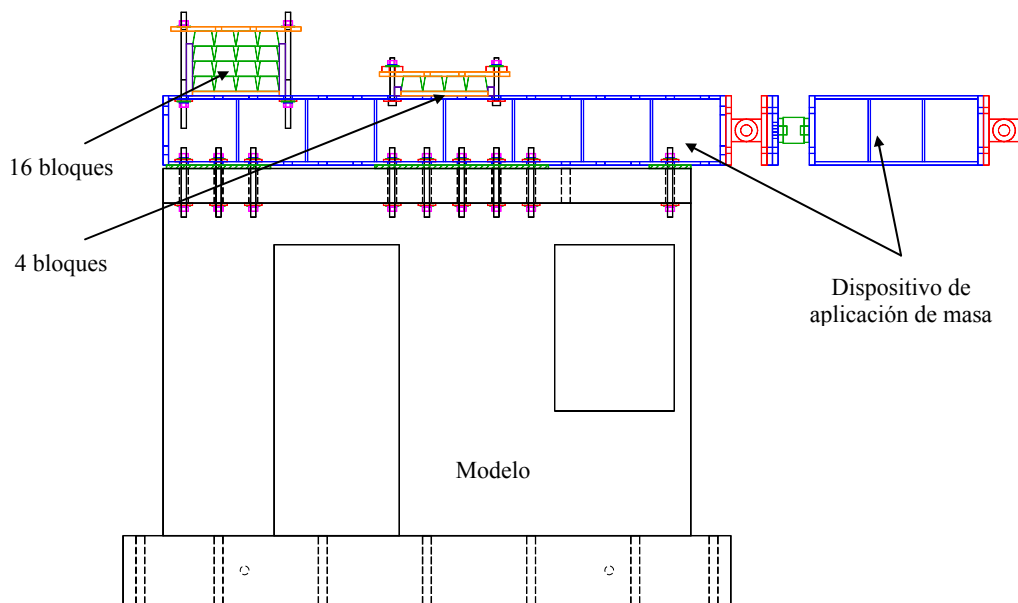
Sistema de aplicación de fuerza axial en los muros con aberturas
